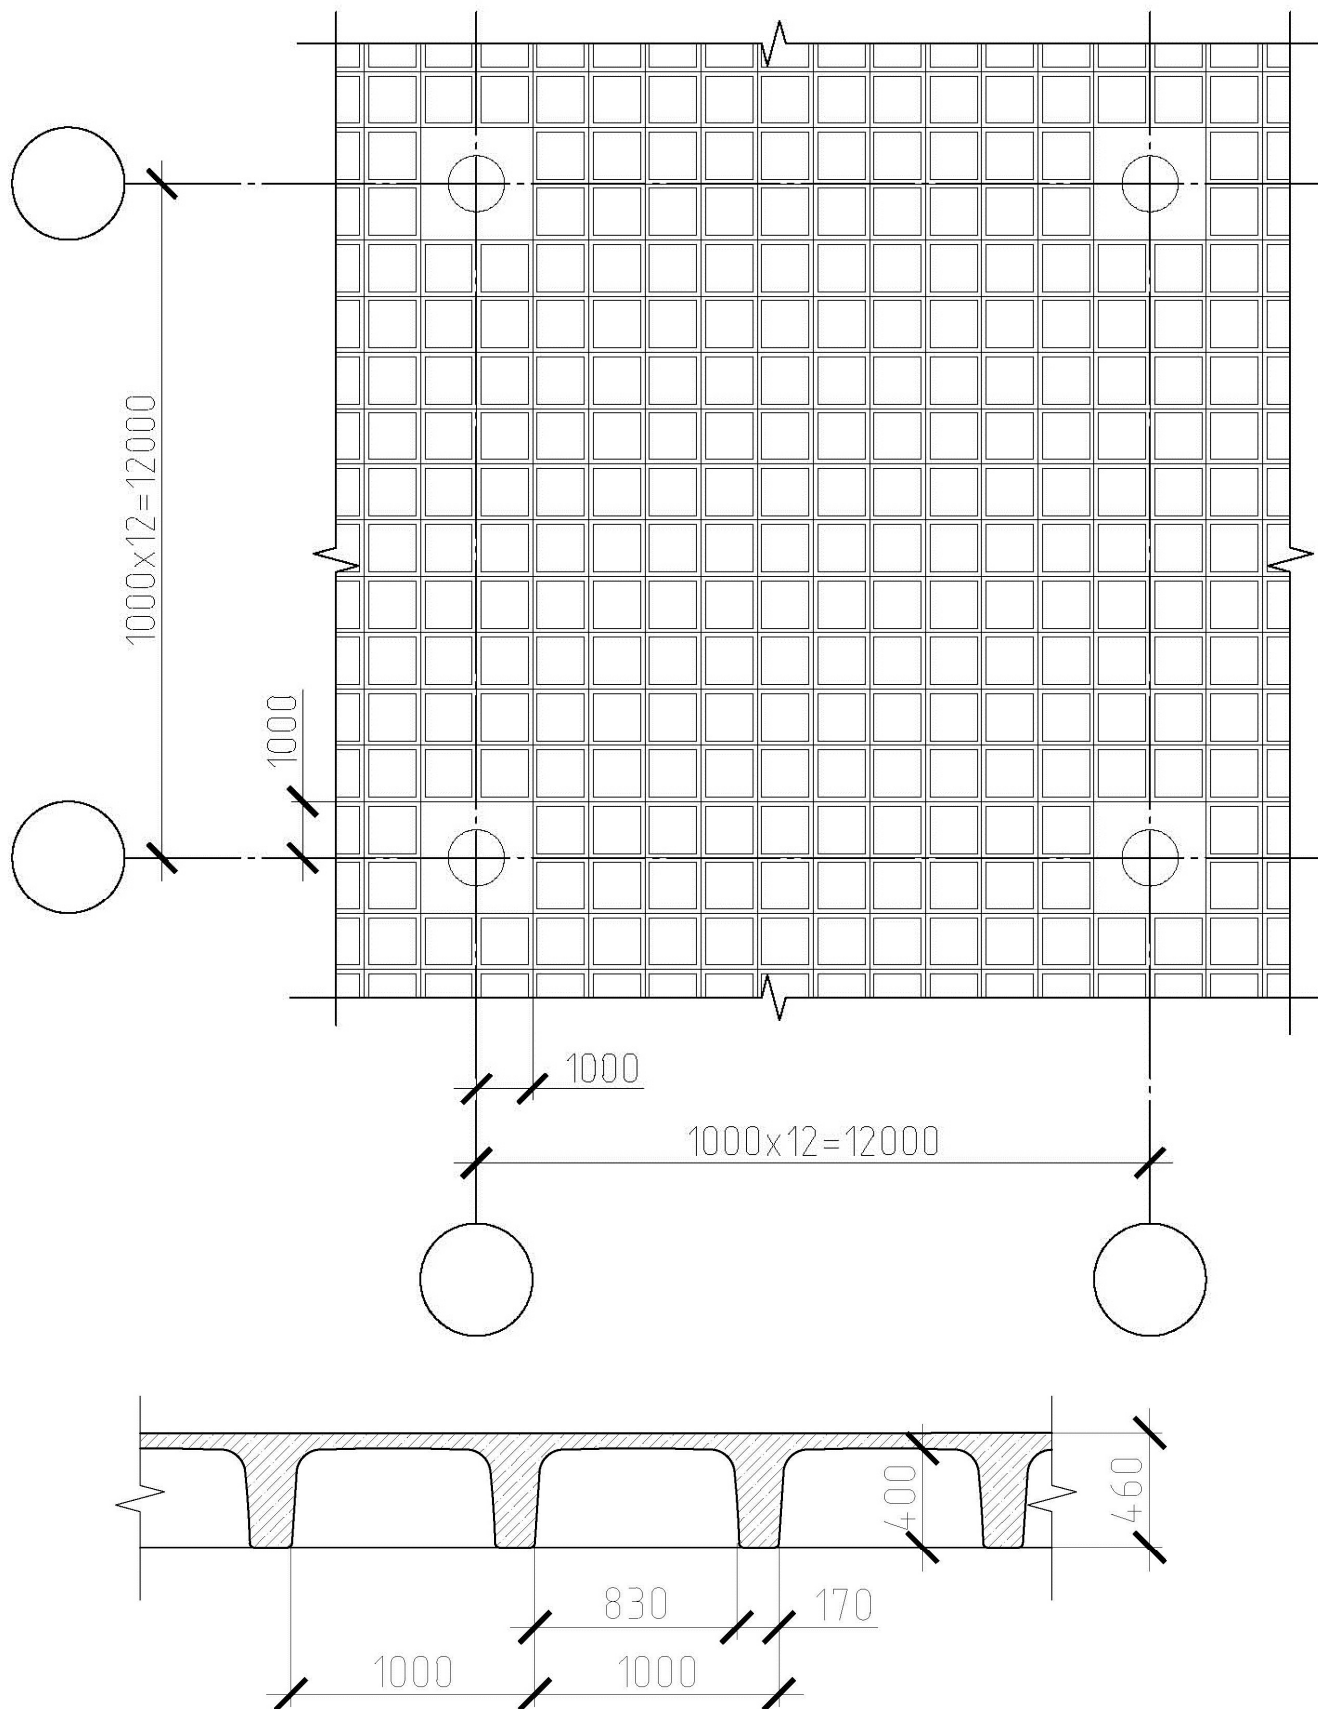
Расположение ребер кессонного перекрытия при шаге колонн 12х12м и нагрузке 1,0т/м.кв.
